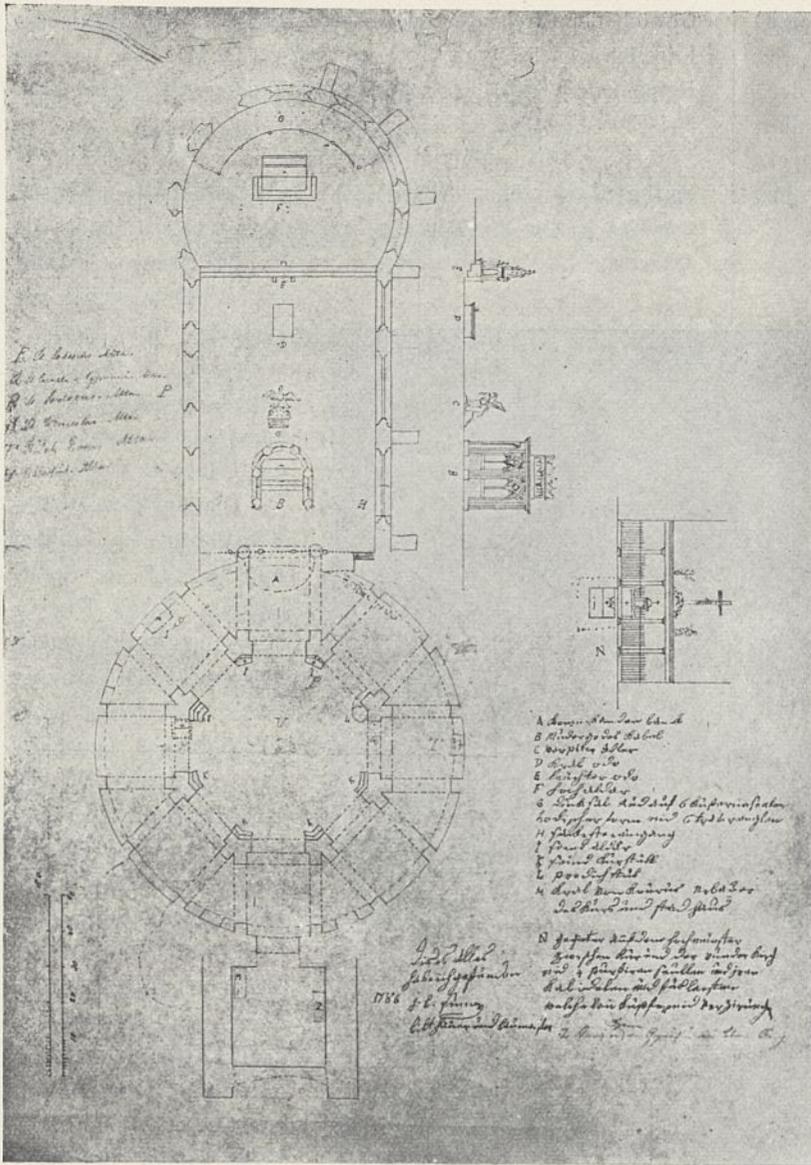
Grundrißskizze des Aachener Münsters von Simar. (Ende des 18. Jahrhunderts.)
